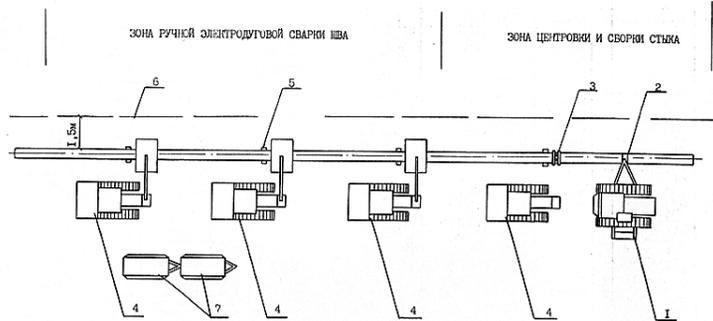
Схема сборки и сварки трехтрубных секций в нитку:
